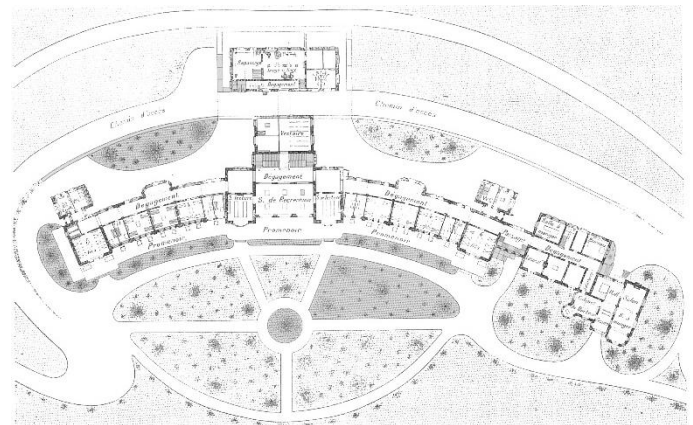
Plan d'origine du rez-de-chaussée du sanatorium de Borgoumont © La construction moderne septembre 1906
